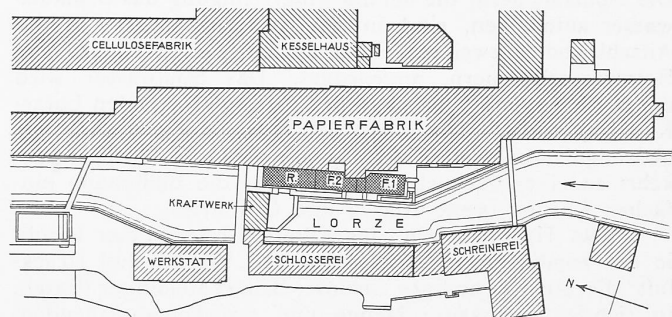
Lageplan der Schnellfilter-Anlage der Papierfabrik Cham, 1 : 2000.
